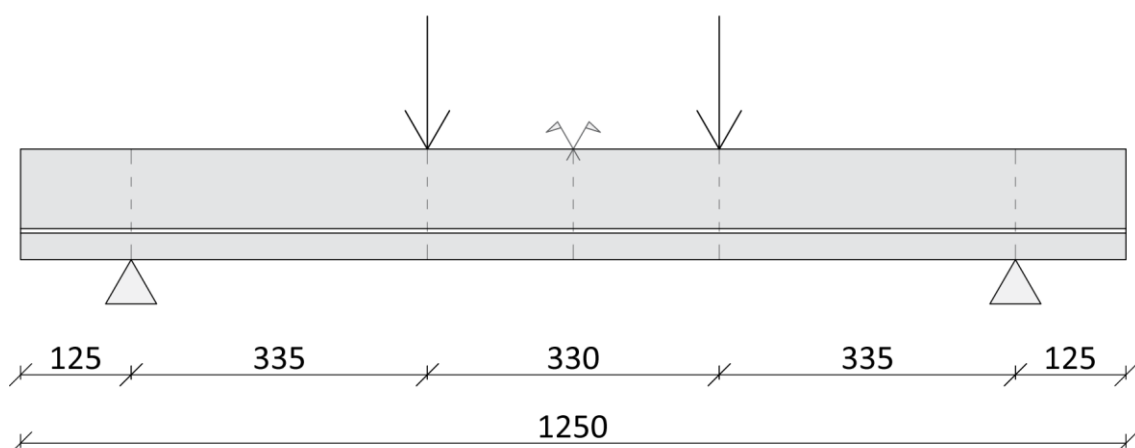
Geometría de la viga compuesta, posición de las cargas y los apoyos.
